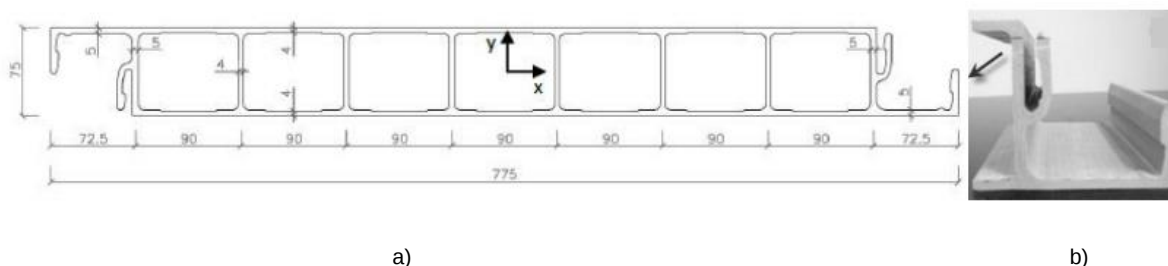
Seções transversais dos painéis a) dimensões (mm) e b) pormenor ligação snap fit (Martinho, 2013).
